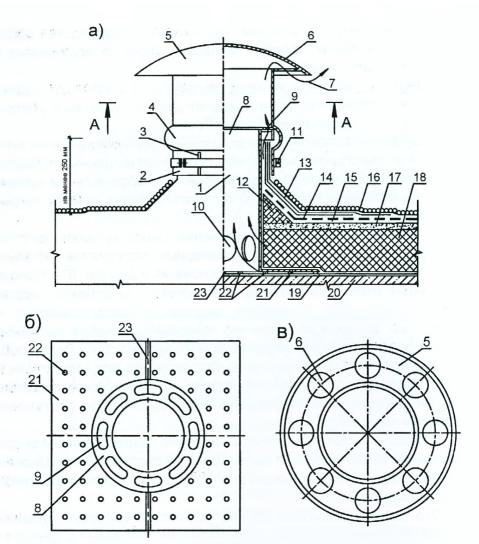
Вытяжное вентиляционное устройство: а)-общий вид и продольный разрез; б)-фланец с патрубком; в)-вид по A-A;
